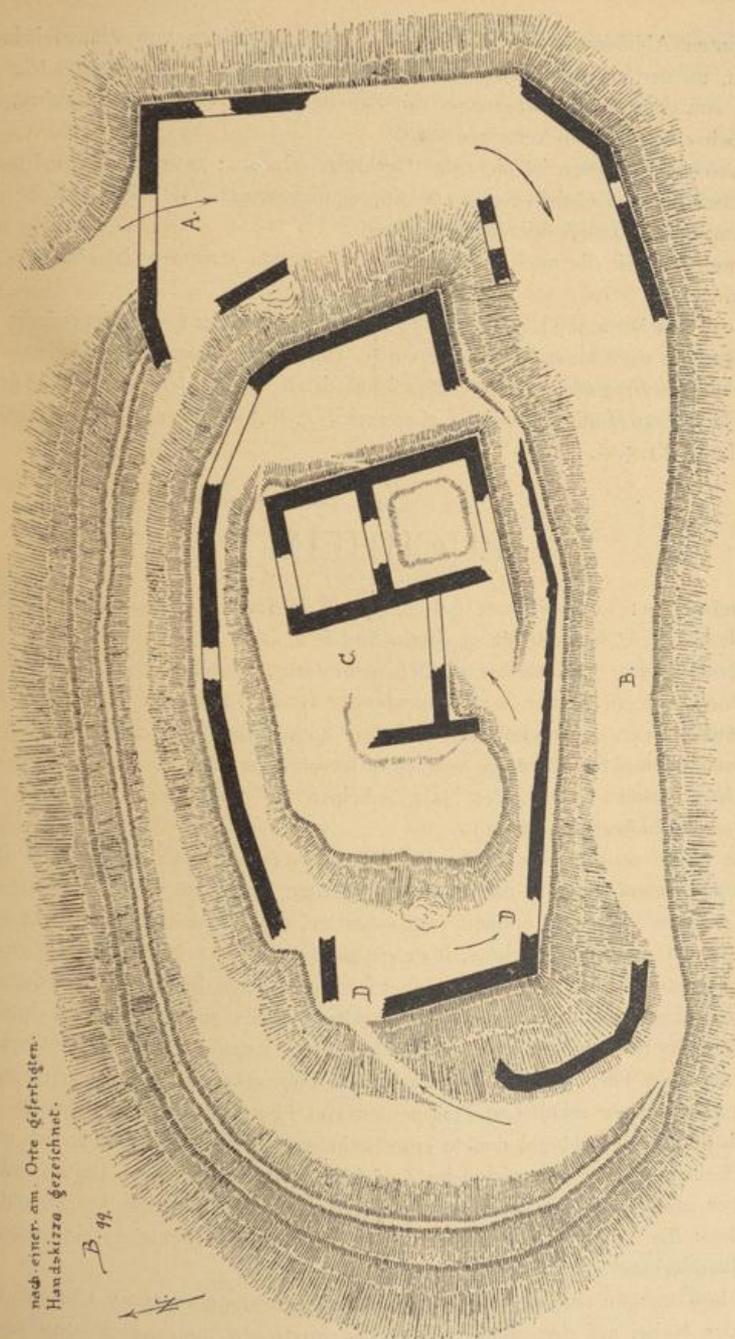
Ruine Wiesneck. Grundriss.
